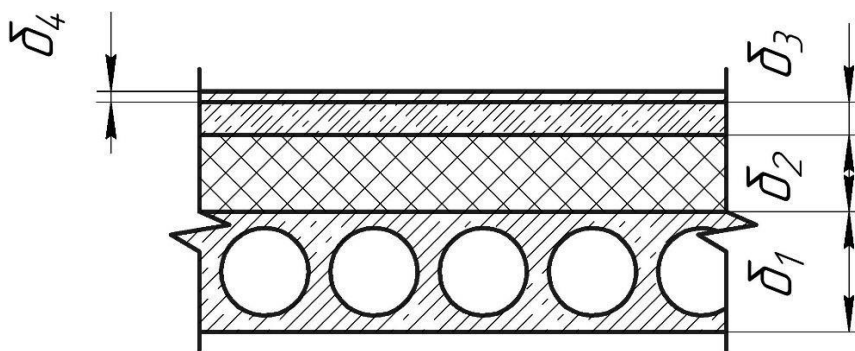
Схема конструкції перекриття над підвалом до теплотехнічного розрахунку
